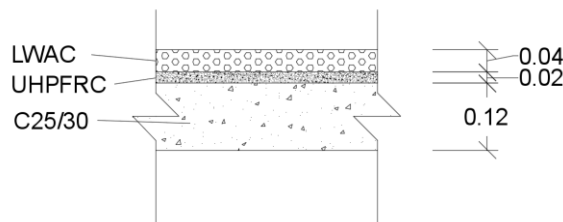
Pormenor do reforço da laje com UHPFRC e LWAC
